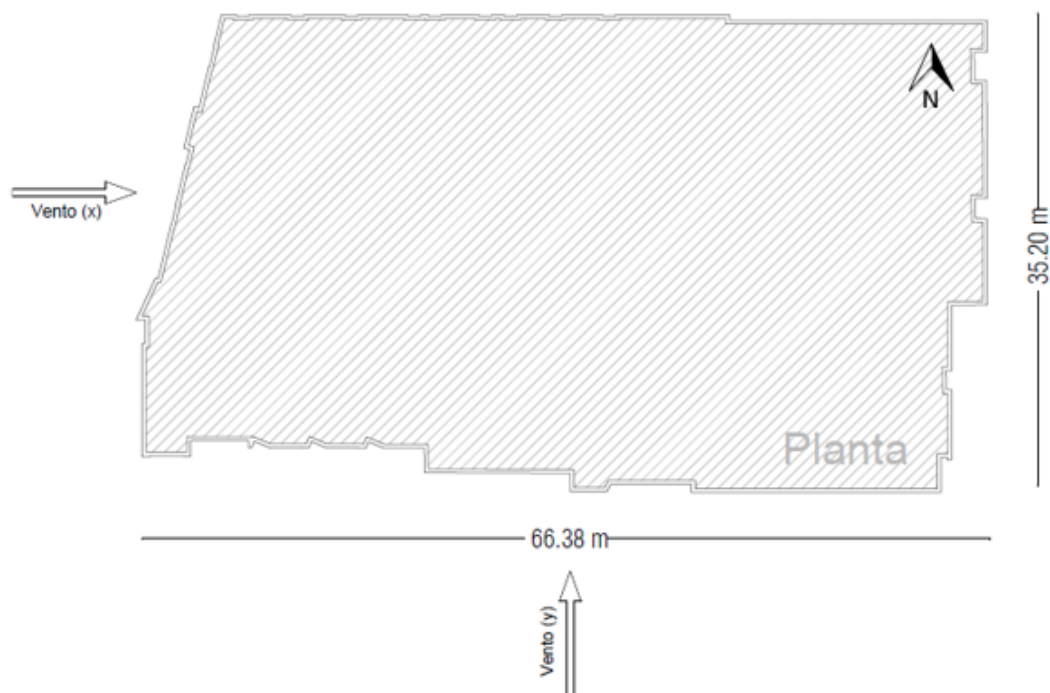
Planta da implantação da Casa de Saúde São Mateus
